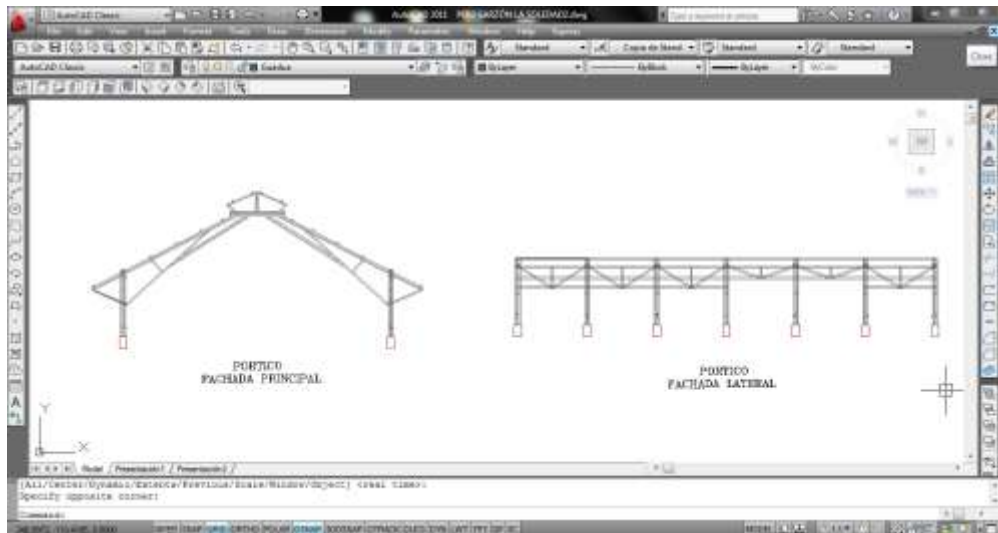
Plano generado en Auto CAD de la geometría inicial de la cubierta, La Soledad
